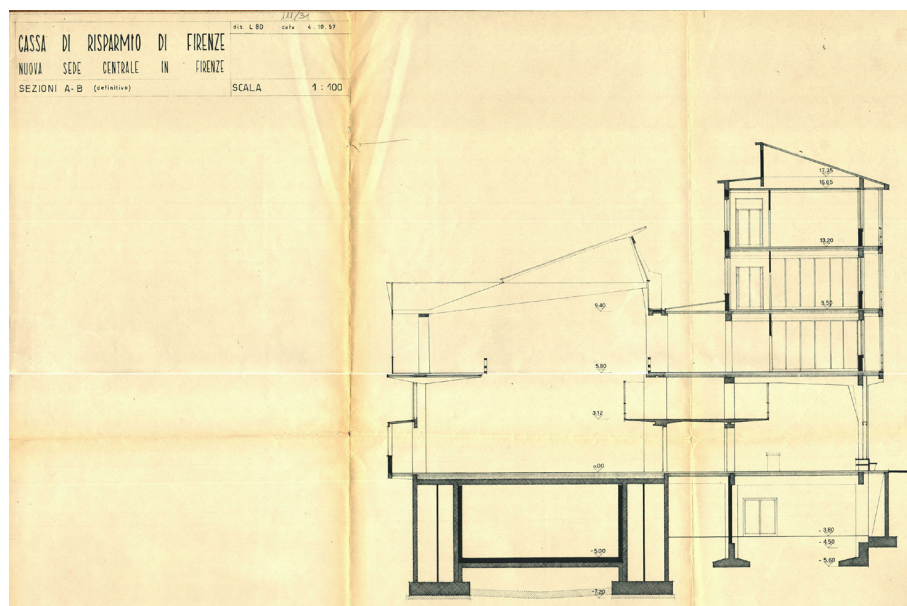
G. Michelucci, sezione A-B progetto definitivo, 4 ottobre 1957.
